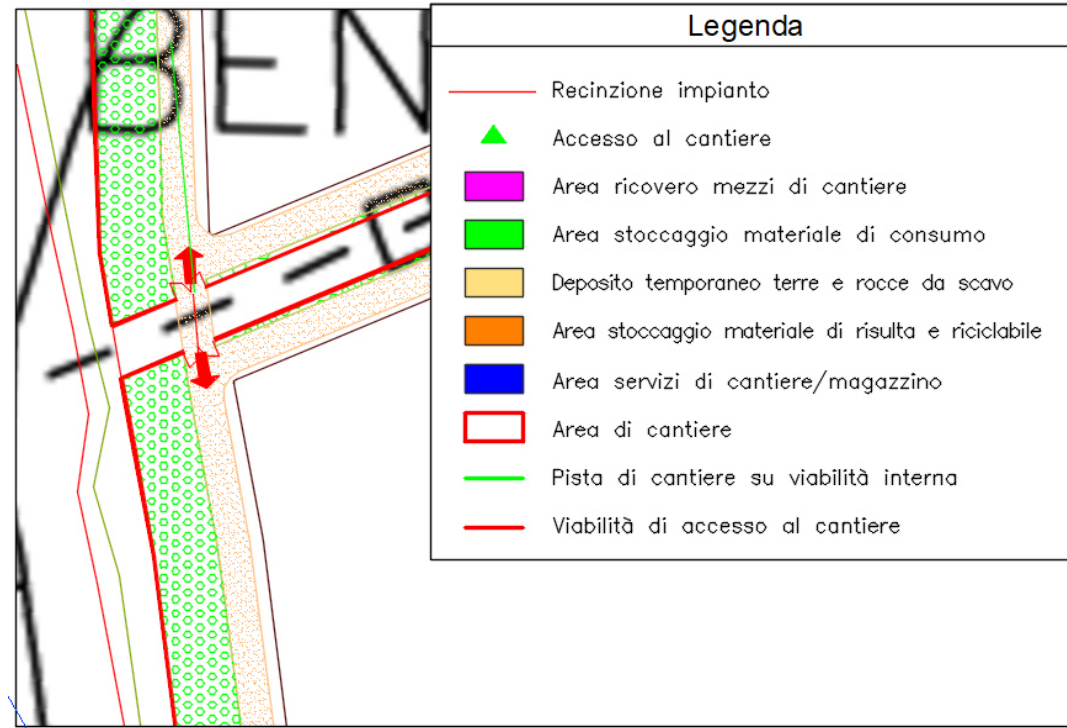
| Particolare accessi 4 e 5 area di cantiere 1
